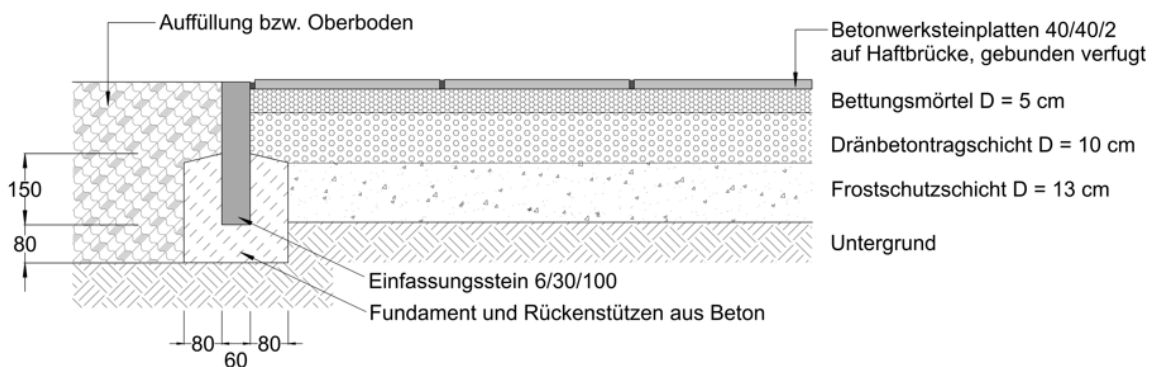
Terrassenaufbau zu Beispiel 1b –Betonwerksteinplatten in gebundener Bauweise
